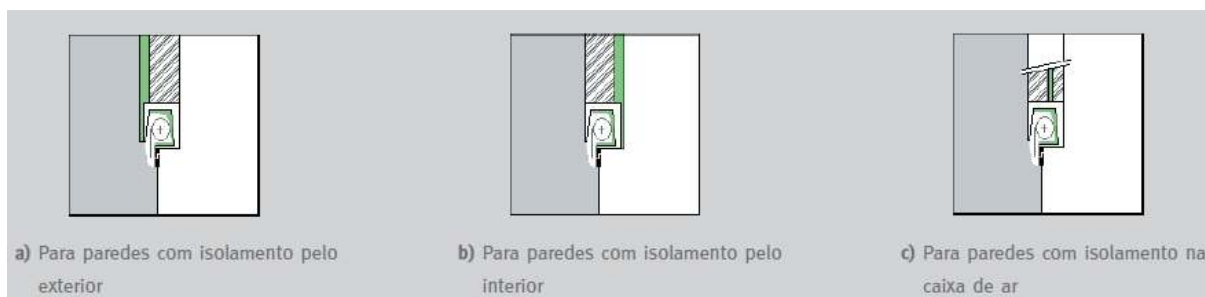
Pormenores de isolamento da caixa de estore [6]
